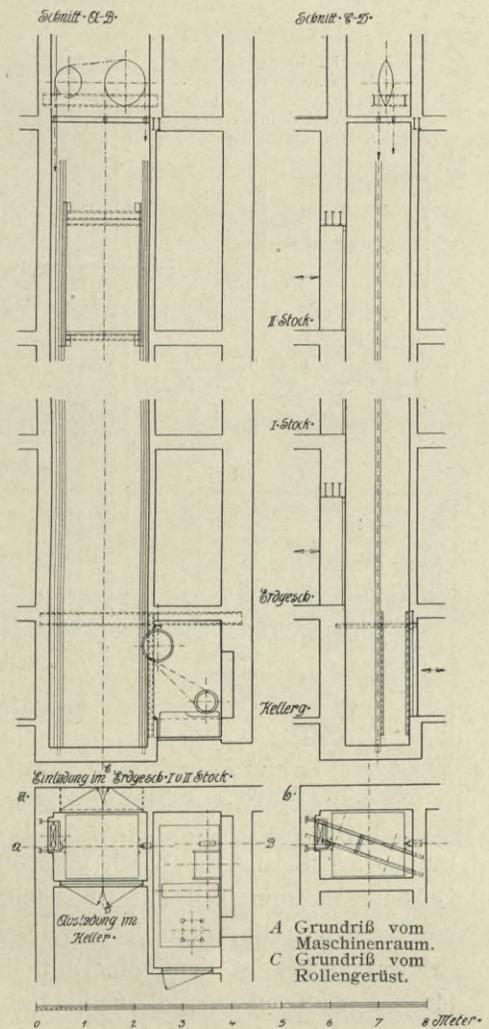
Organ.-chem. Institut. Aufzug. Grundrisse und Schnitte.
